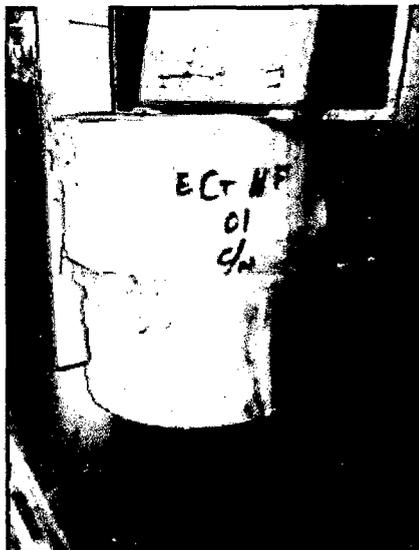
Especimen para ensayo de corte o cizallamiento //.
